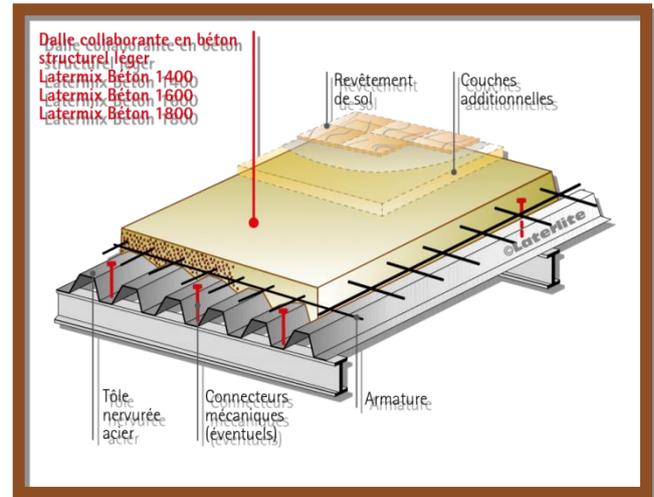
détail plancher collaborant. source: <https://www.batiproducts.com/>
